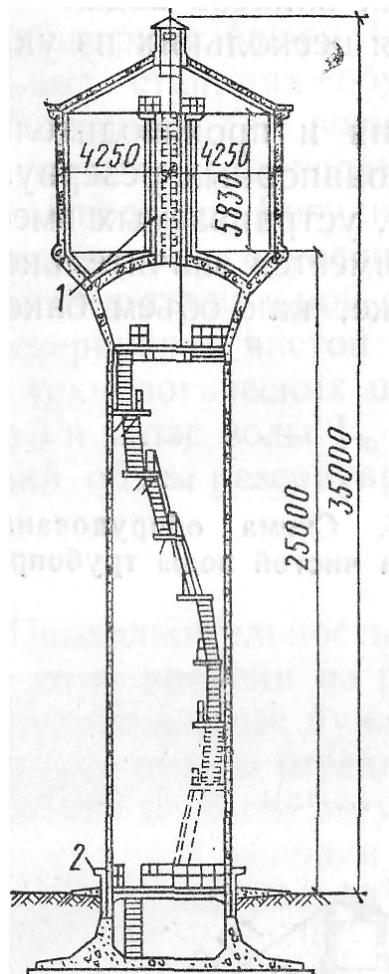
Железобетонная водонапорная башня с цилиндрическим стволов
